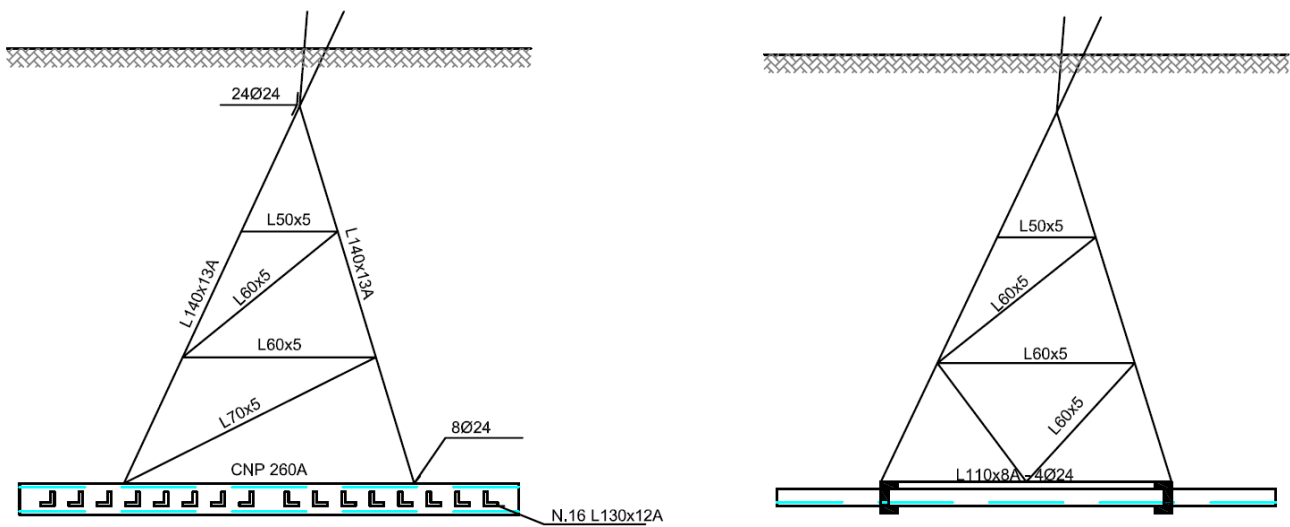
Schema fondazioni metalliche. Le dimensioni dei profilati metallici variano in funzione del tipo di sostegno cui è associata la fondazione
